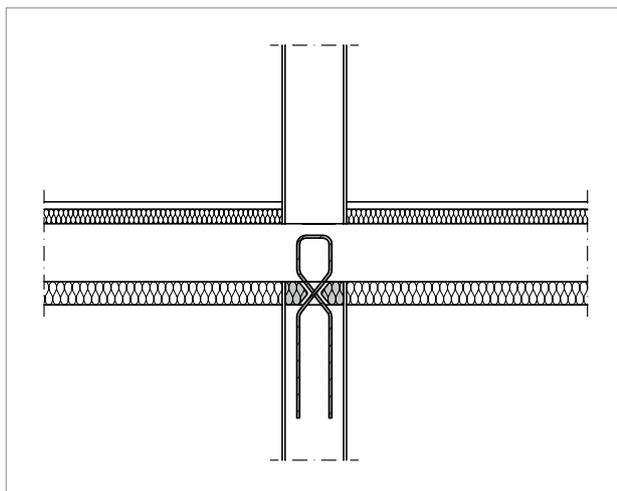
Darstellung einer Schnittzeichnung mit detailliertem Schöck Sconnex® Modell
